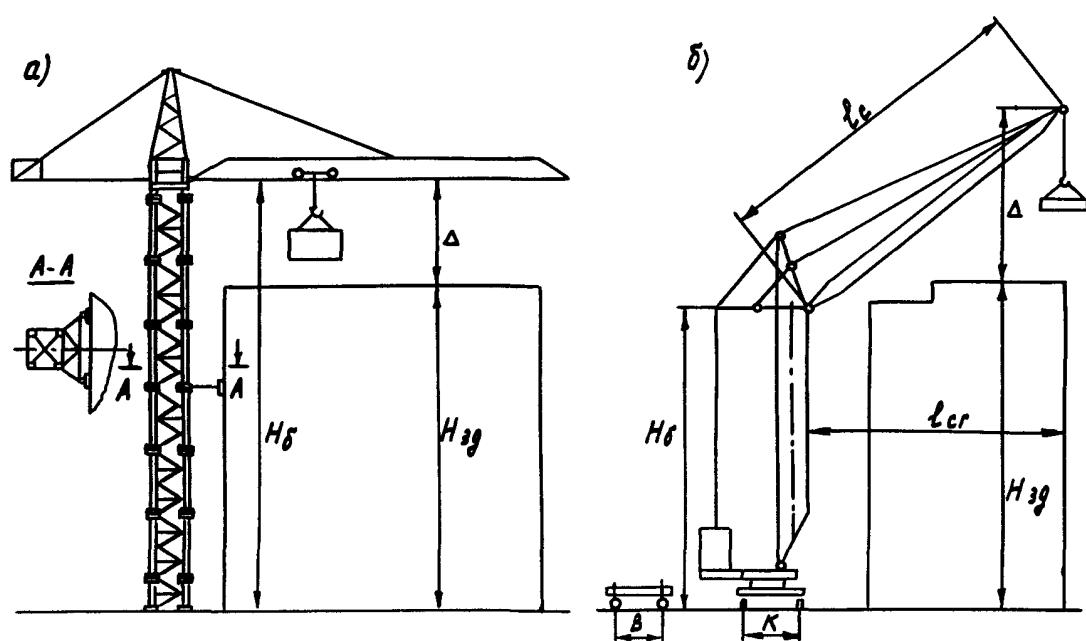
Схемы установки строительных кранов: а - приставного; б - передвижного
